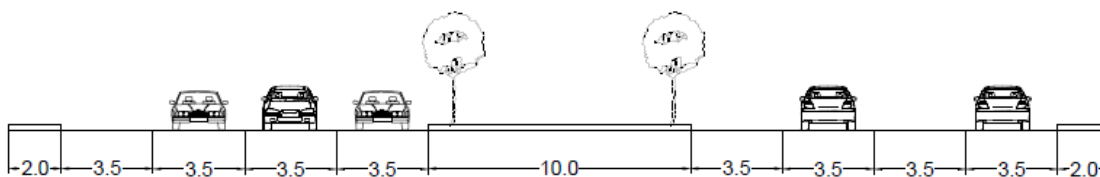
Sección Transversal Av. Winston Churchill. (Fuente: Elaboración Propia).
